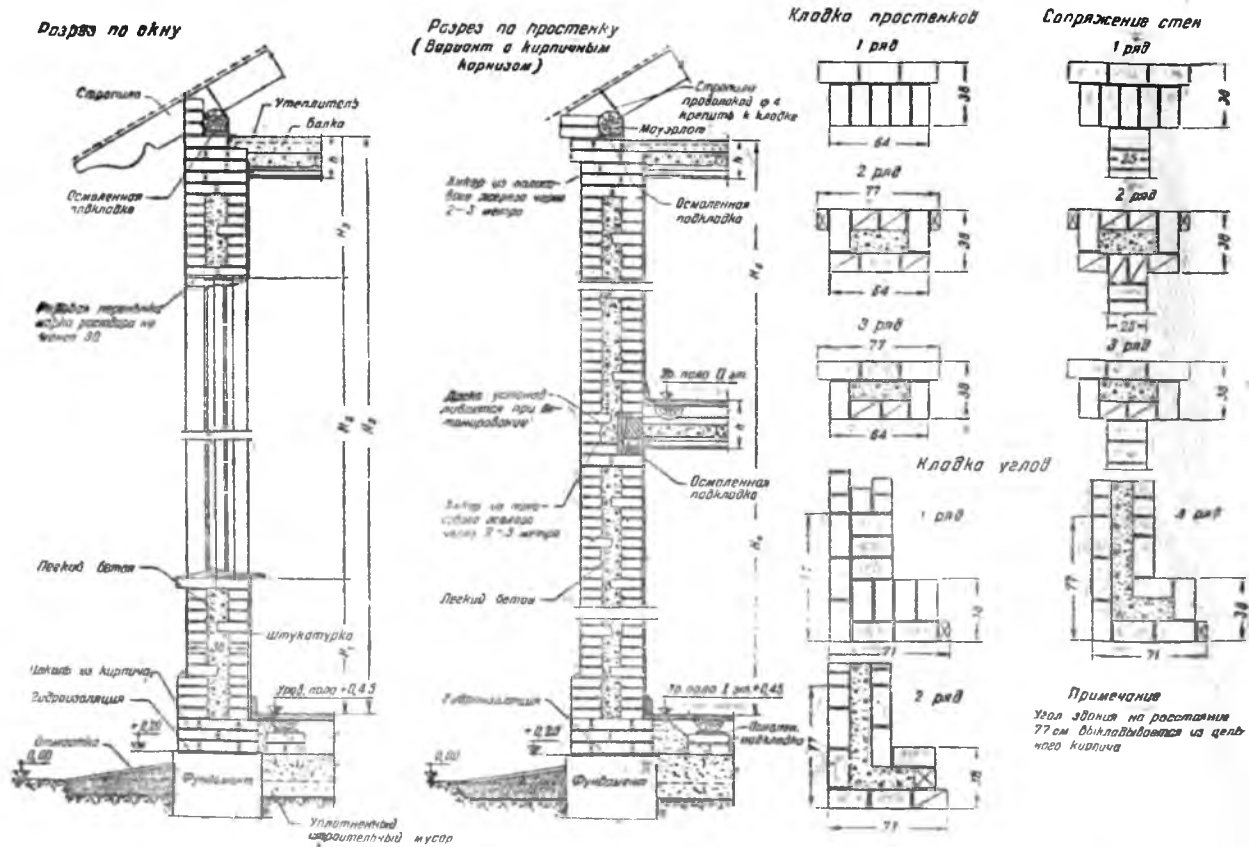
Кирпичебетонные стены. Разрезы, детали кладки простенков, углов и сопряжения стен
